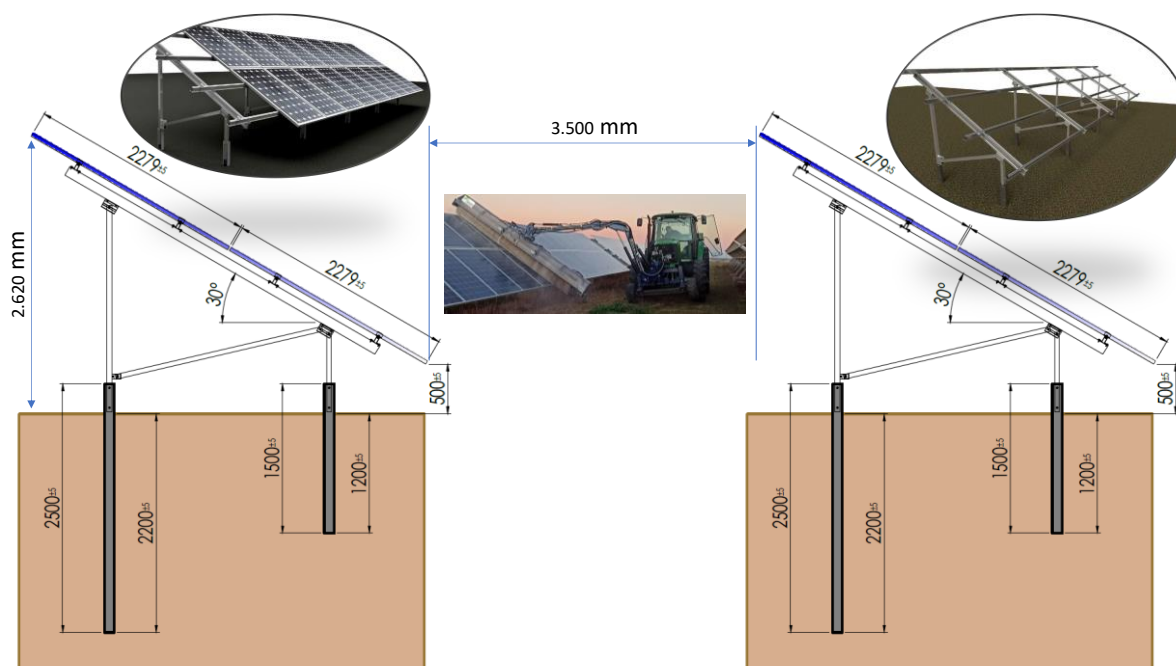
Disposición de las hileras de estructuras de soporte de los paneles en la planta fotovoltaica del Pantaleu
